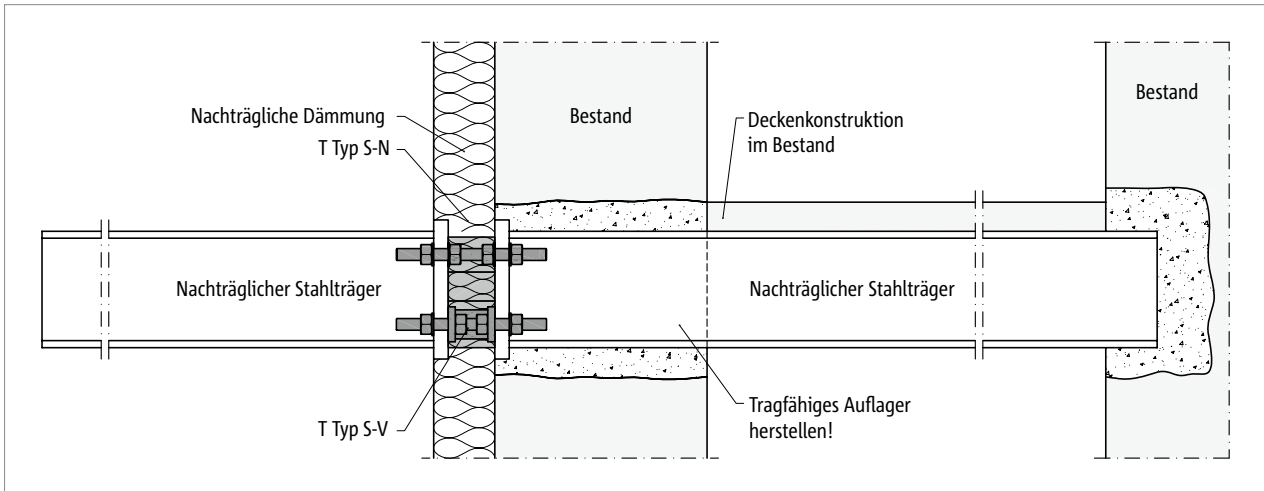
Schöck Isokorb® T Typ S-N und T Typ S-V: Nachträglicher Stahlbalkon frei auskragend; angeschlossen an nachträglich eingebauten Stahlträger
